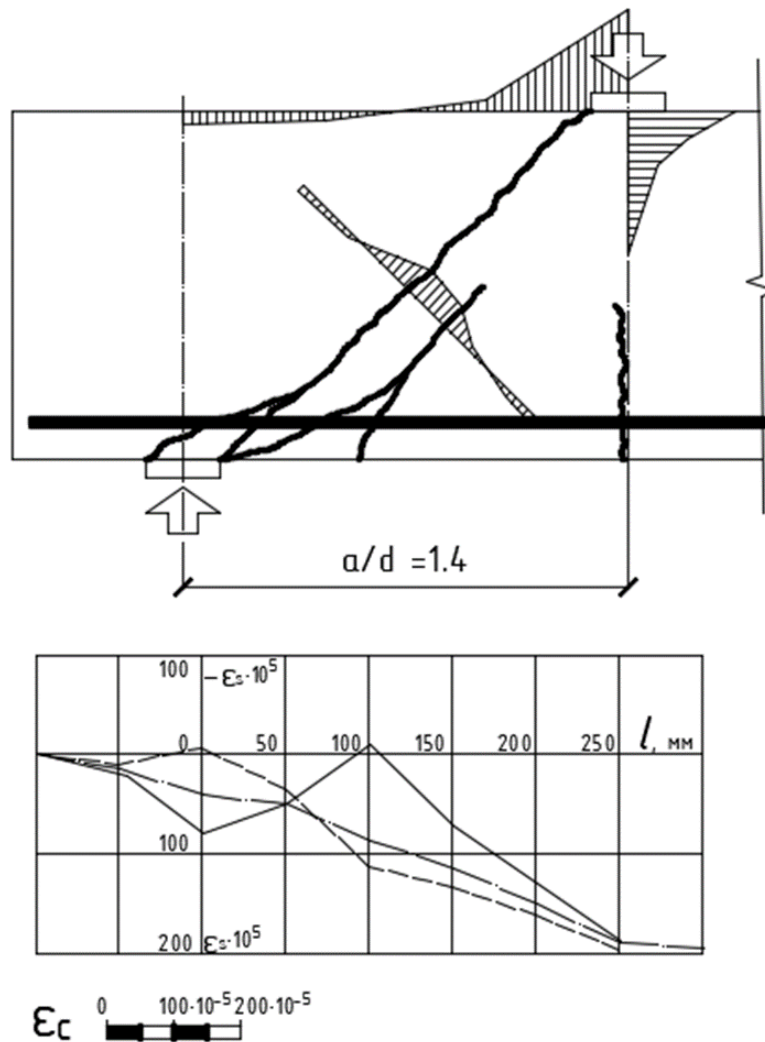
Напружено-деформований стан бетону, повздожньої арматури балок 1 серії (без поперечної арматури)
